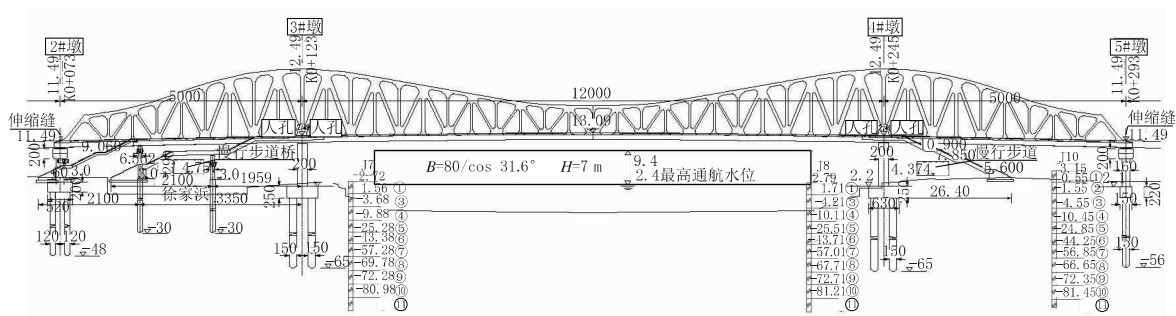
苏州新叶桥沿中心线展开立面图(单位:mm)
